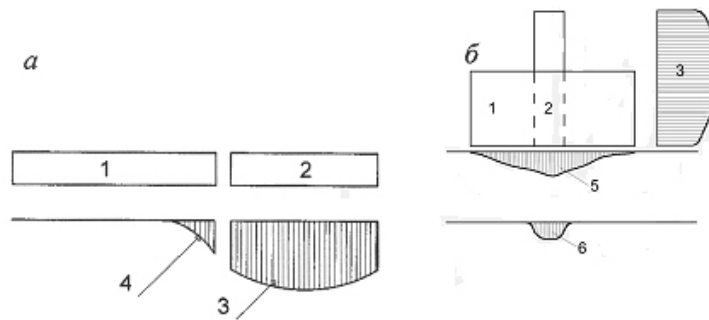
Розвиток додаткових осад за різного влаштування примикання будівель: *а* – торцями; *б* – до поздовжньої стіни: 1 – існуюча будівля; 2 – нова будівля; 3 – епюра осад нової будівлі; 4 – епюра додаткової осад старої будівлі; 5 – те саме по вісі *Б*; 6 – те саме по вісі *А
